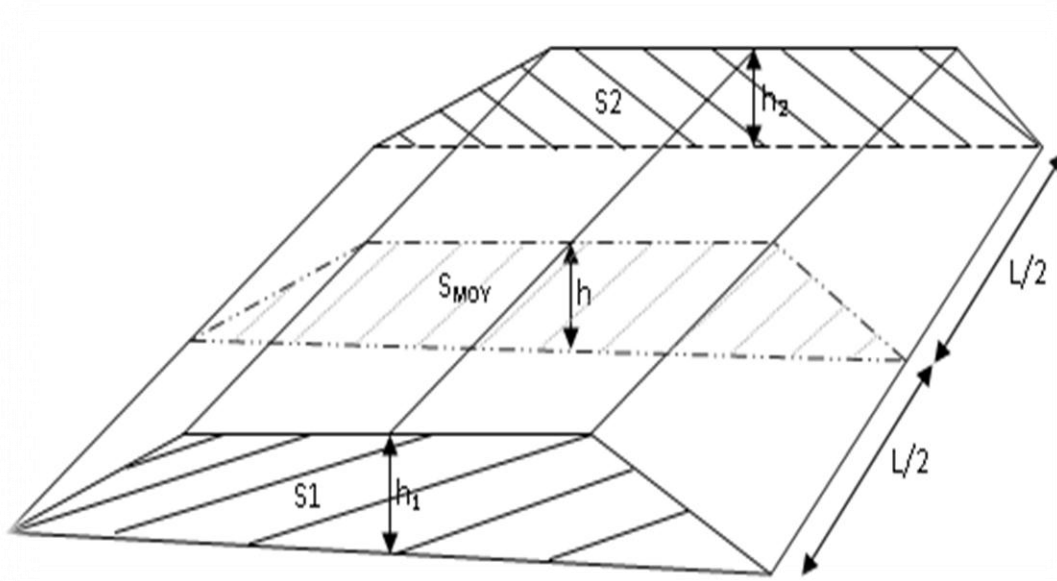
Les sections des profils en travers d'un tracé donné
